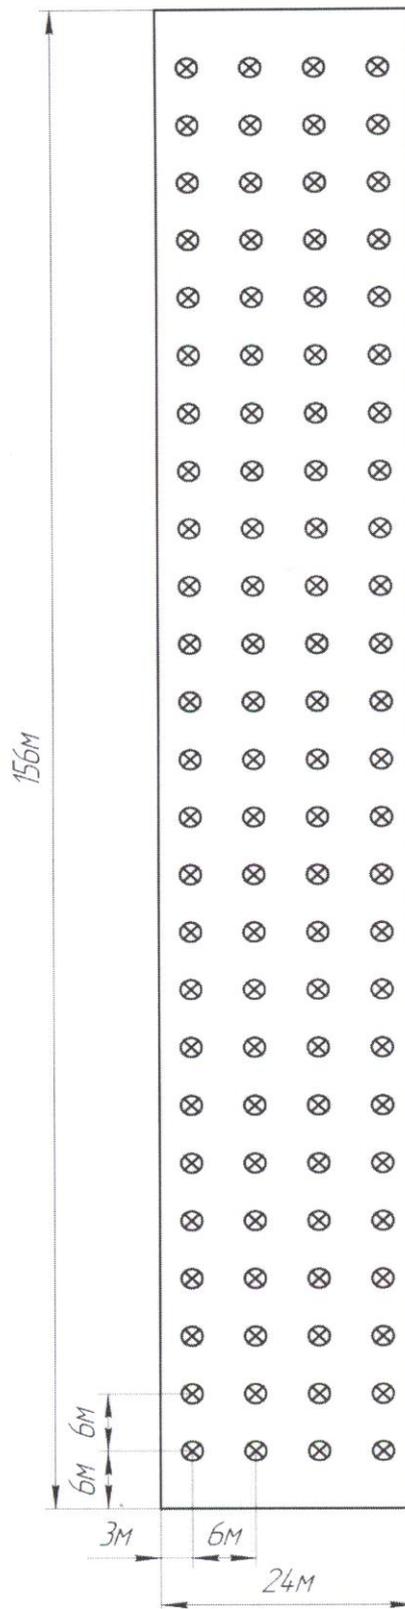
Схемотехнический расчет расположения светильников до реконструкции в помещении 1
